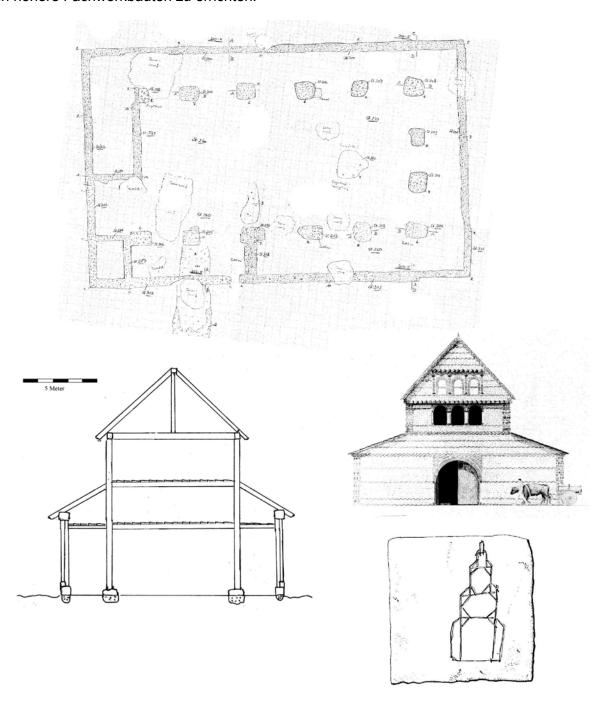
Bau 3 des Fundplatzes HA 488, Grundriss (oben), Rekonstruktion (unten links). Fassade des Wirtschaftsbaus von Meonstoke (unten rechts oben). Die Ritzzeichnung aus London (unten rechts unten) zeigt ein höheres Gebäude in Fachwerkbautechnik. (Abb.: Meonstoke: King 1996, 67; Ziegelplatte: Bédonyère 2001, 12.)
